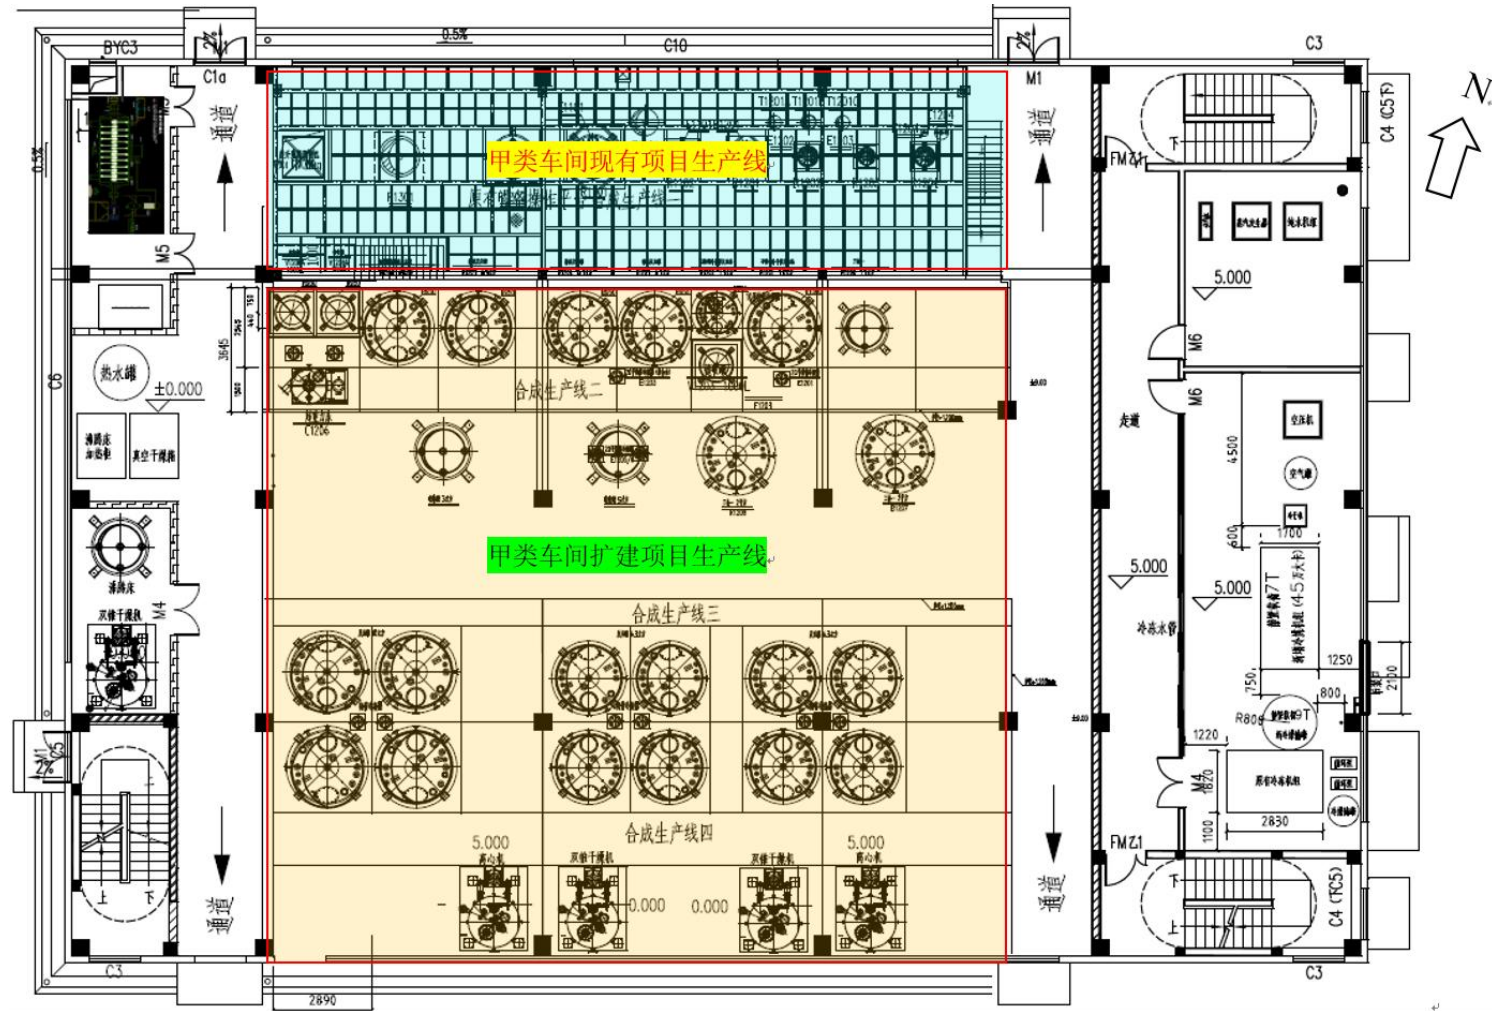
扩建项目车间设备布置平面图（甲类车间）
